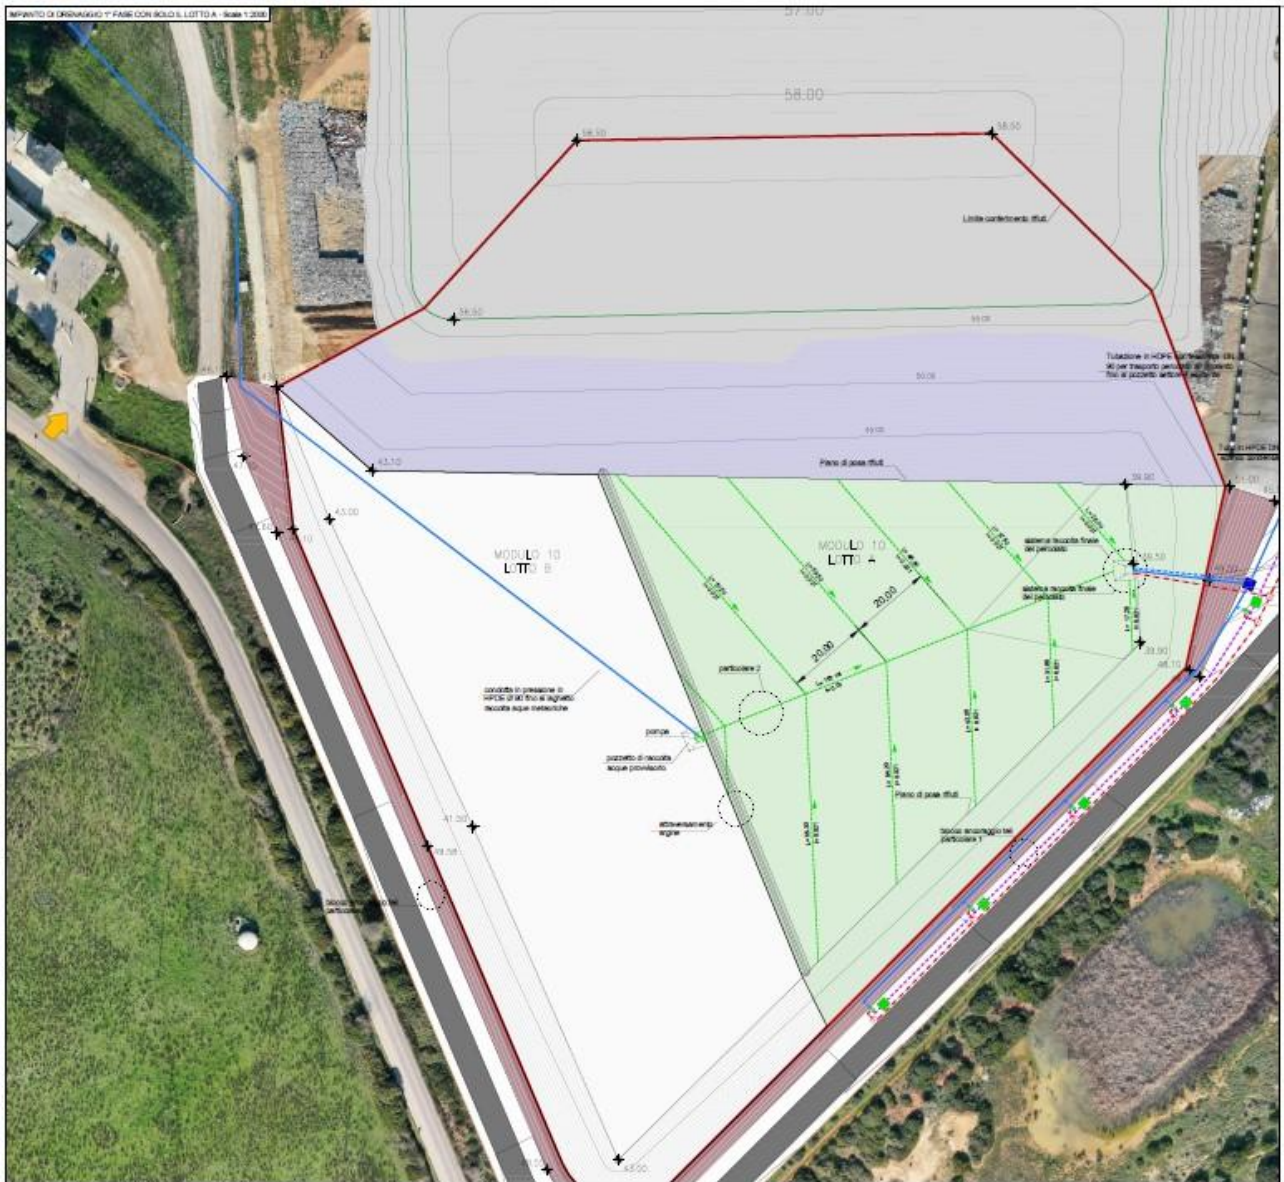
Planimetria nuovo Modulo 10 e suddivisione in lotto A e Lotto B
